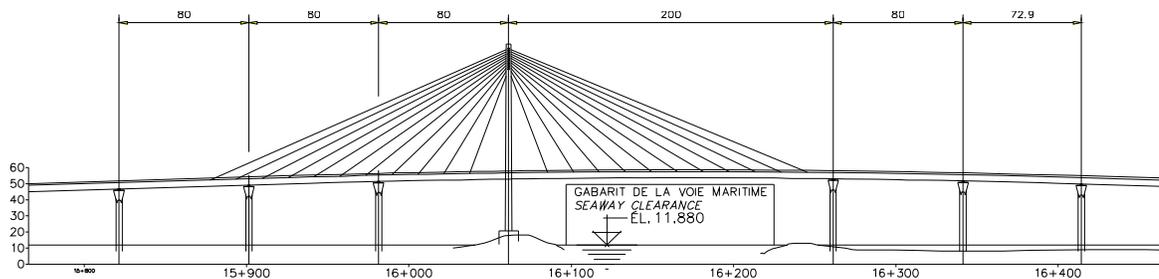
Coupe transversale – Pont à haubans – Solution bipoutres
